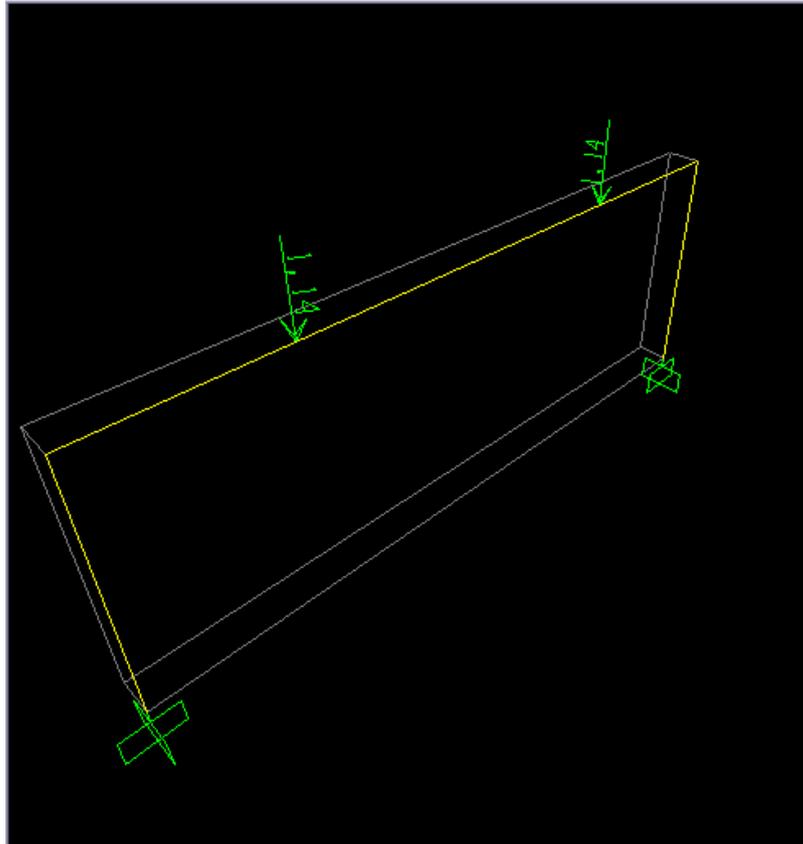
MODELO TRIDIMENSIONAL DEL PÓRTICO CON LAS CARGAS APLICADAS
